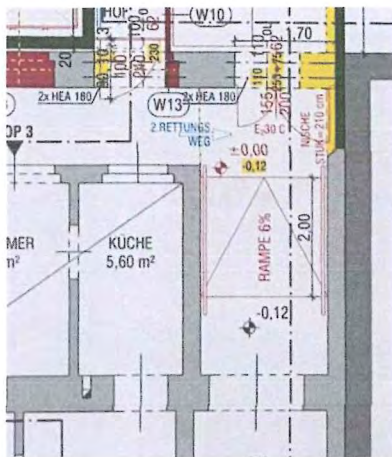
Einreichplan DG-Ausbau, Rampe im Eingangsbereich
